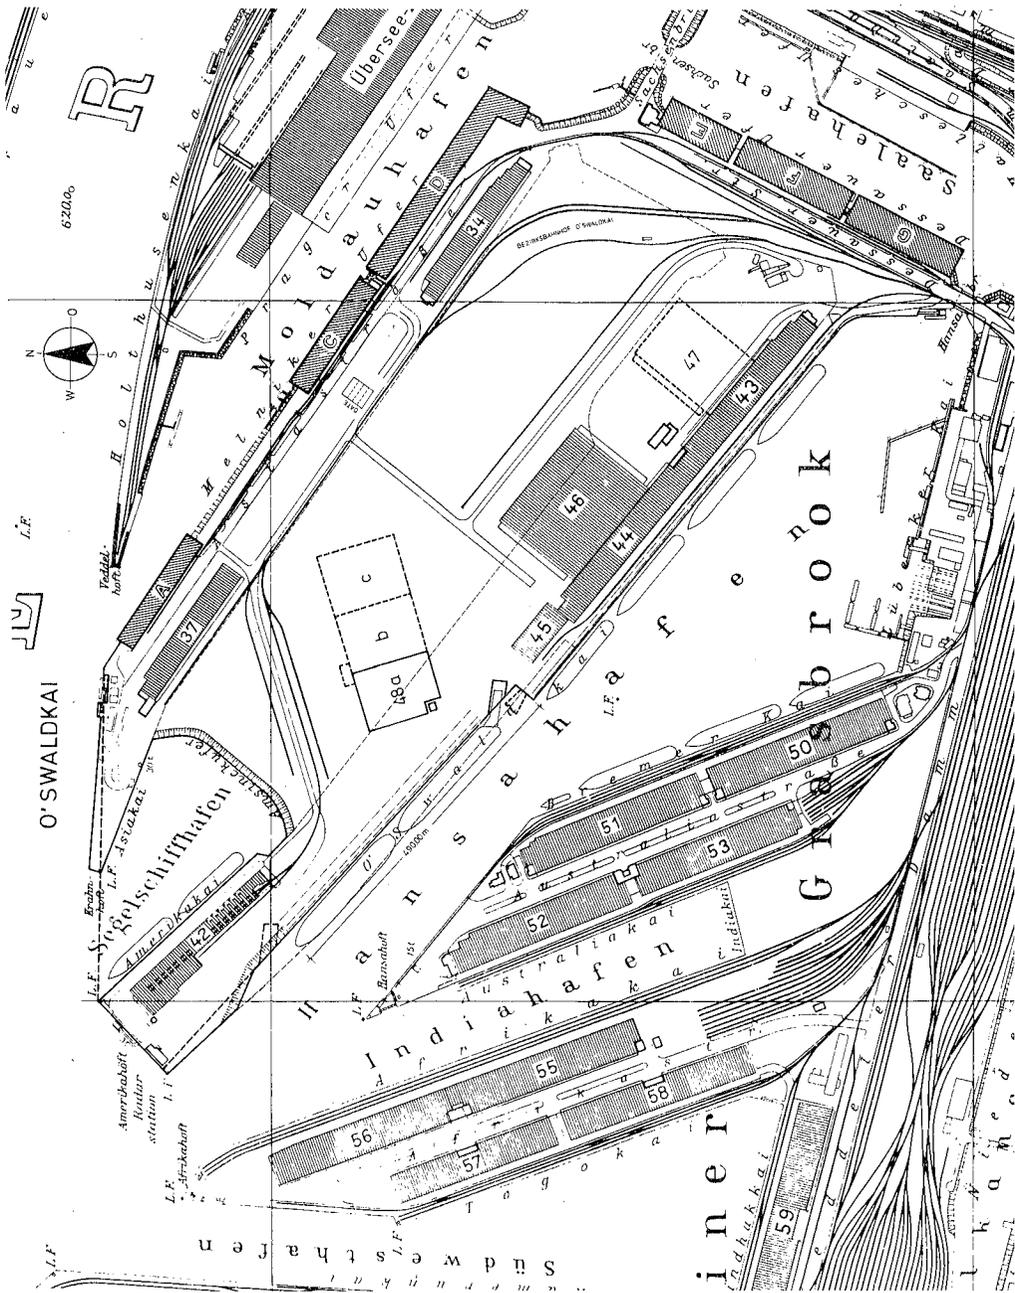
Lageplan des Terminal O'Swaldkai (3. Baustufe)
